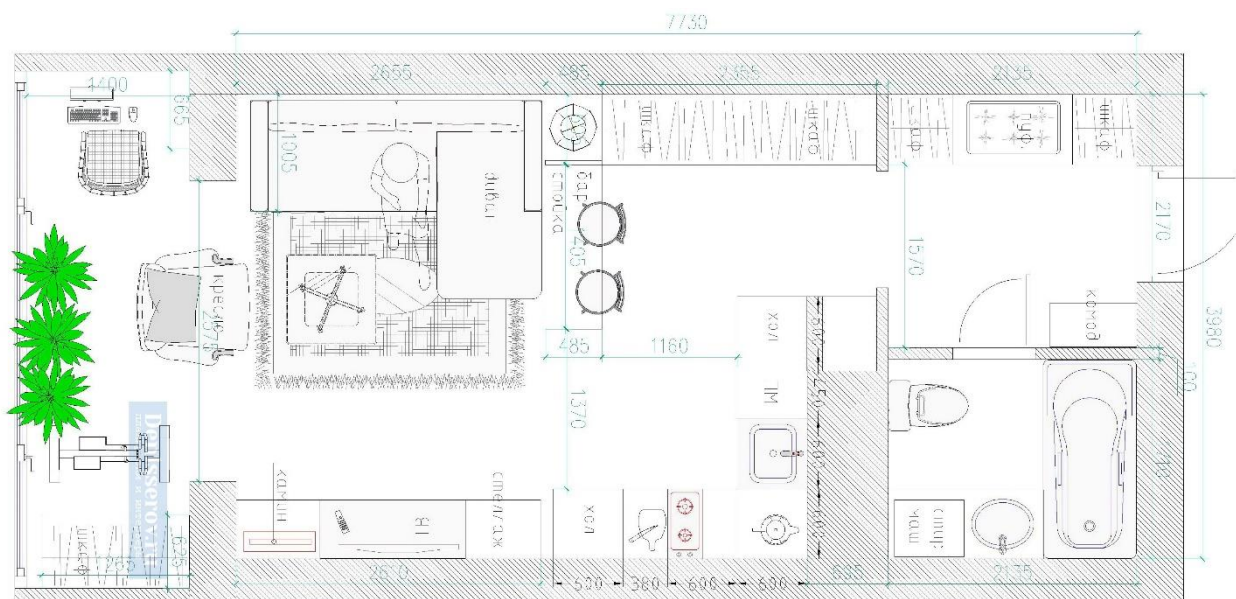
Планировка студии площадью 30 м<sup>2</sup> без подоконного блока
